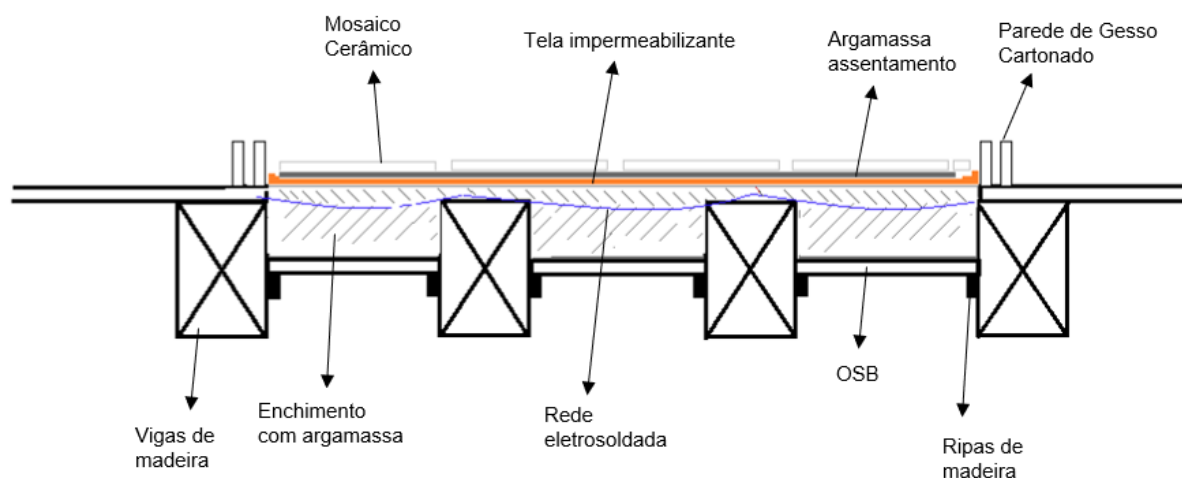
Pormenor construtivo do pavimento da casa de banho
